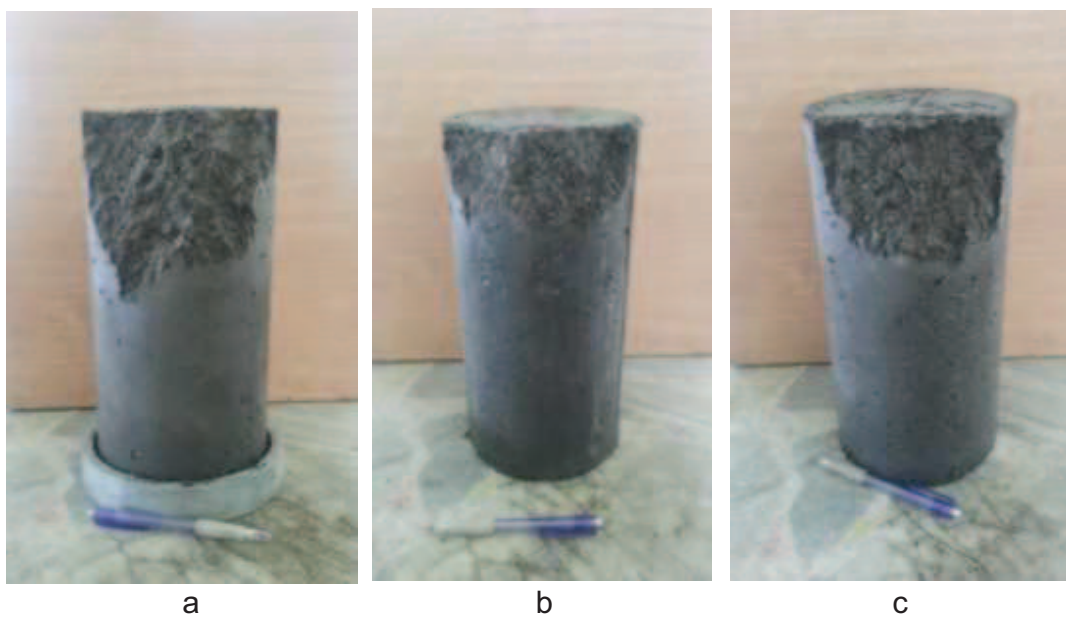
Fracturas de probetas cilíndricas: a- hormigón convencional; b- hormigón con escoria de acero; c- hormigón con escoria de acero y aditivo.
